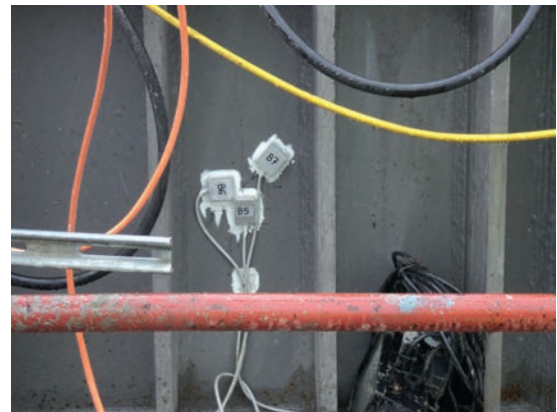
Detalle de los extensómetros dispuestos en el alma de la viga de cuelgue.
